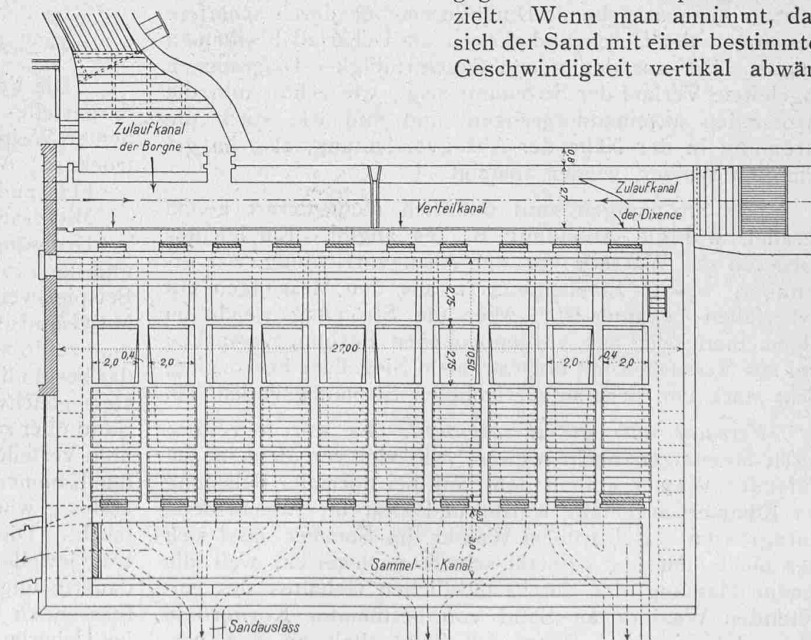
Entsandungsanlage der A. J. A. G. im Sauterot, Wallis. — Grundriss 1 : 300.
